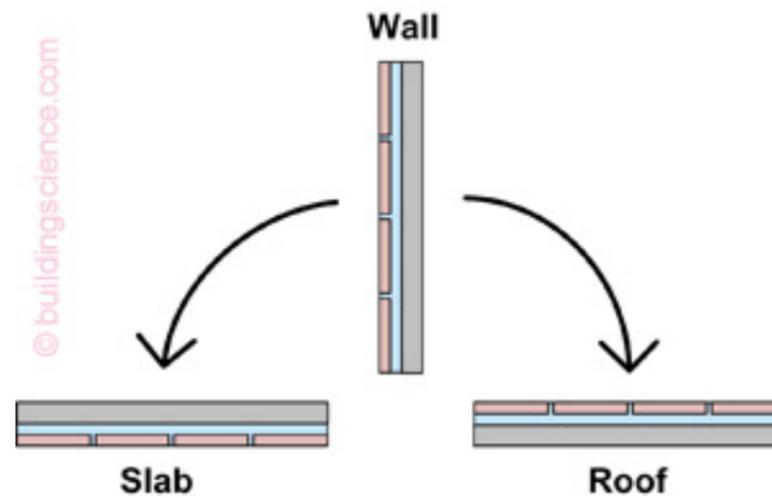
Muro, techo, losa. Fuente: Building science. Elaboración: Building science. (2020).
